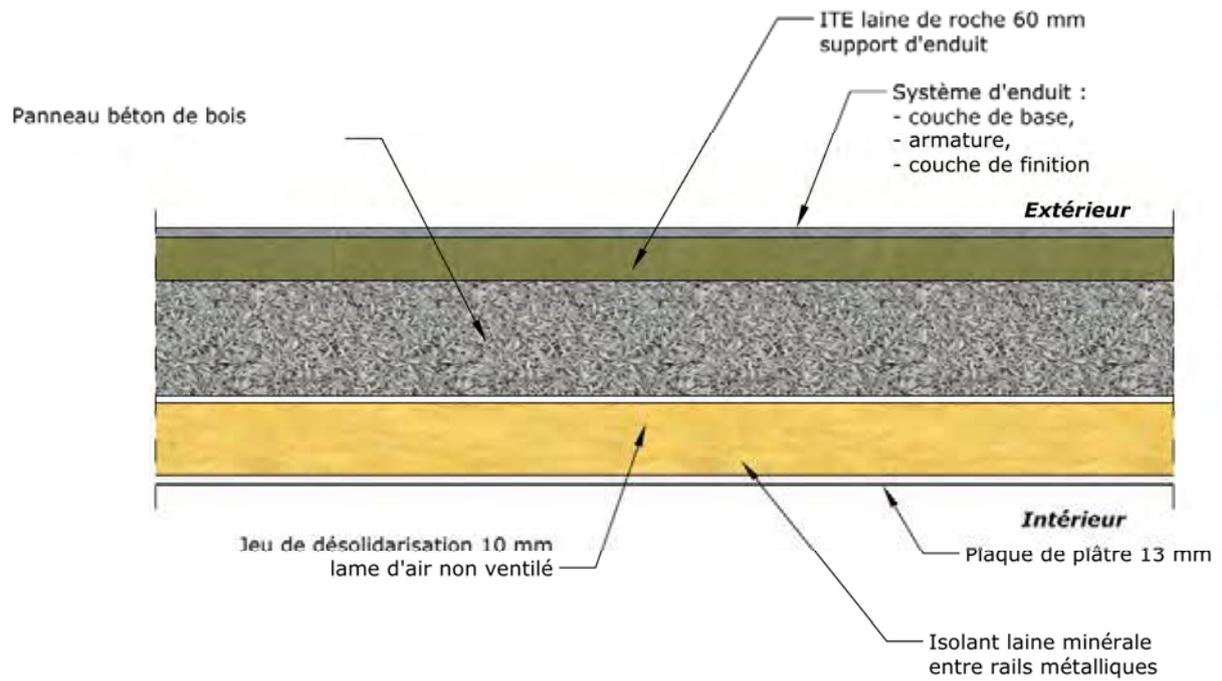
Exemple partie courante Panneau avec enduit extérieur
